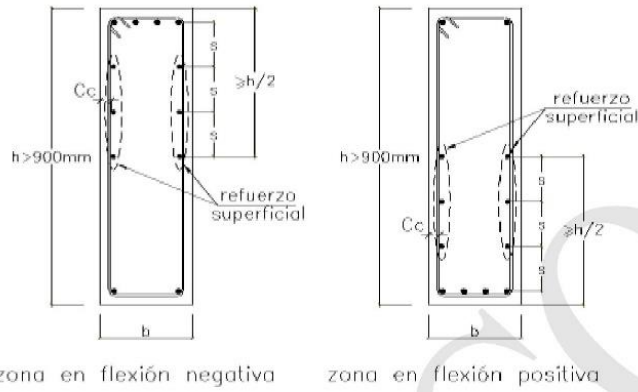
Refuerzo superficial en vigas con peralte mayor a 900 mm
